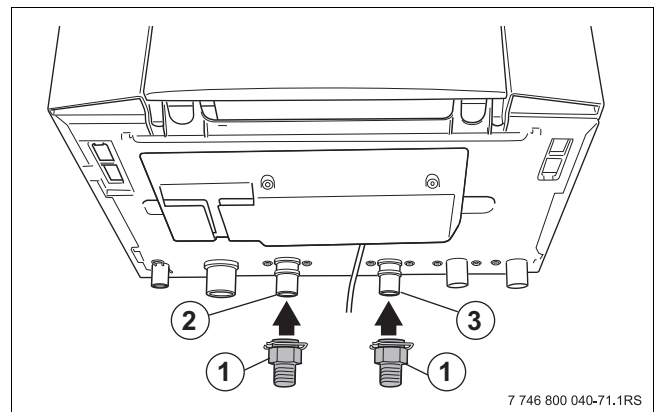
Rohrleitungen für externen Warmwasserspeicher montieren
